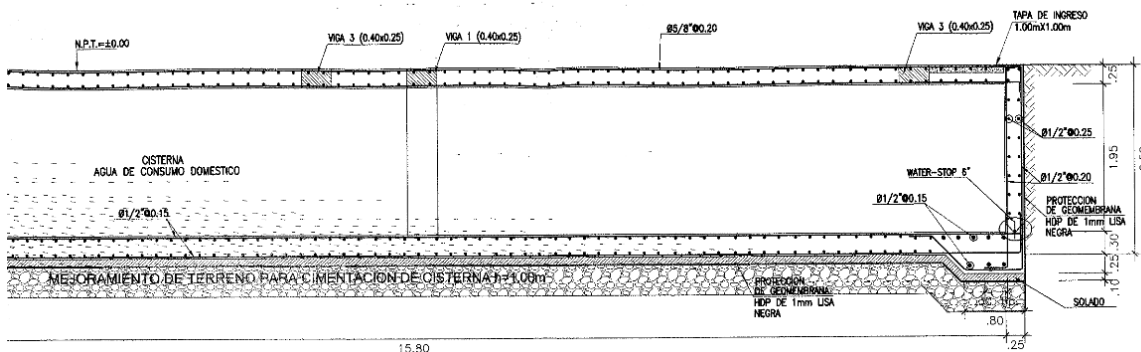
Mejoramiento de terreno y protección con geomembrana. Fuente: Plano estructural del
